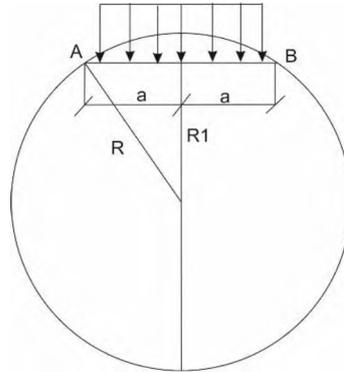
Расчетная схема при равномерно распределенной нагрузке под подошвой фундамента.
